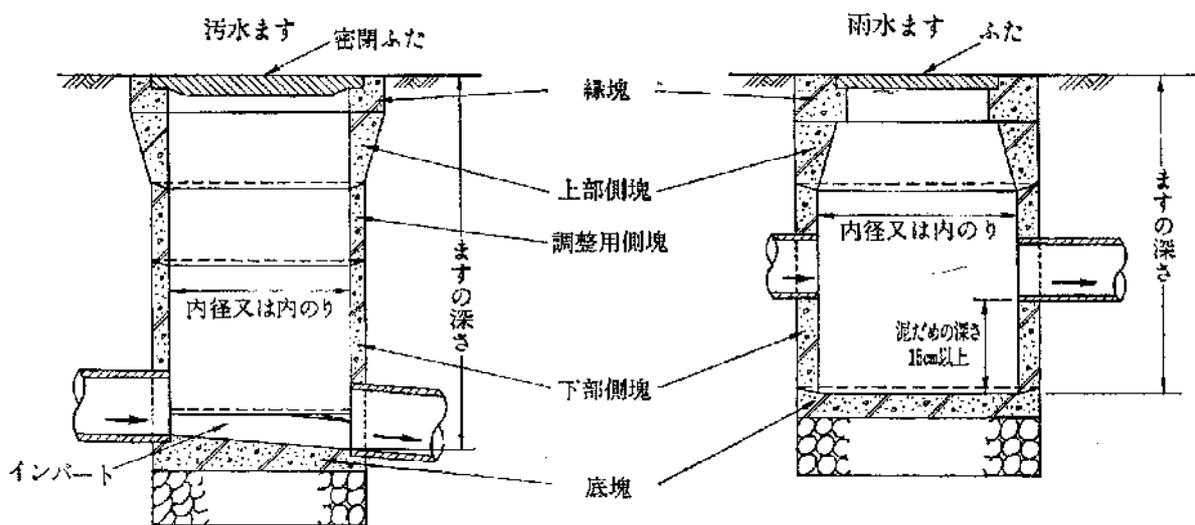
鉄筋コンクリート製ますの例 (既製ブロック使用)
